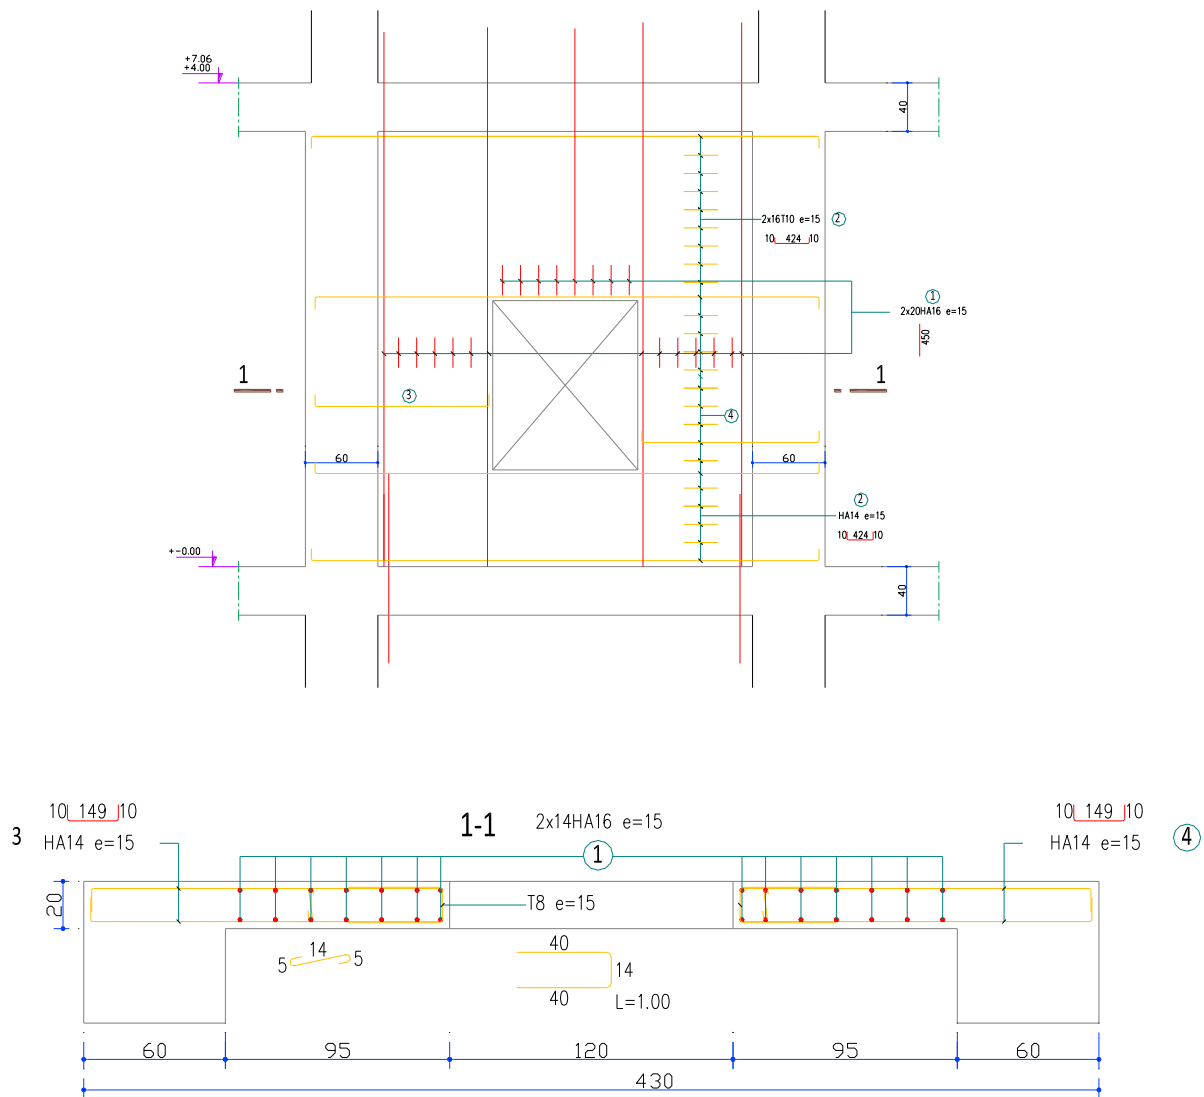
Ferrailage du voile $V_{T1;T5}$ de niveau RDC.
